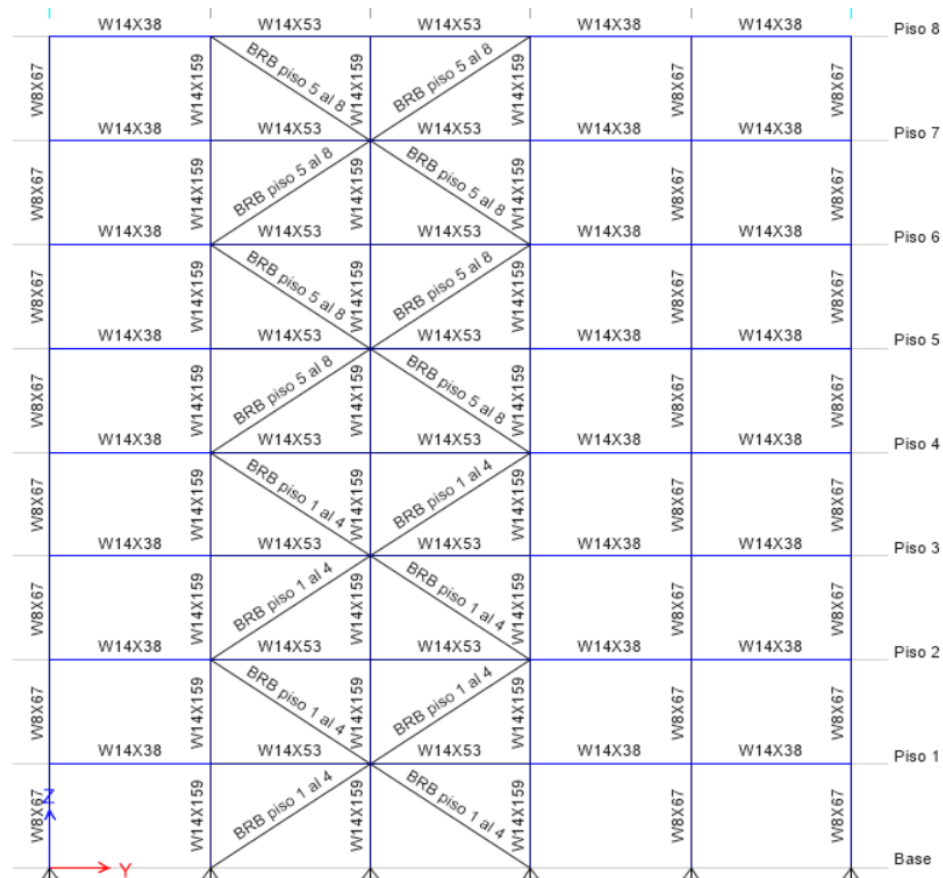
25: Vista en elevación de la estructura con arriostramiento externo. Estructura mixta 8 pisos.
